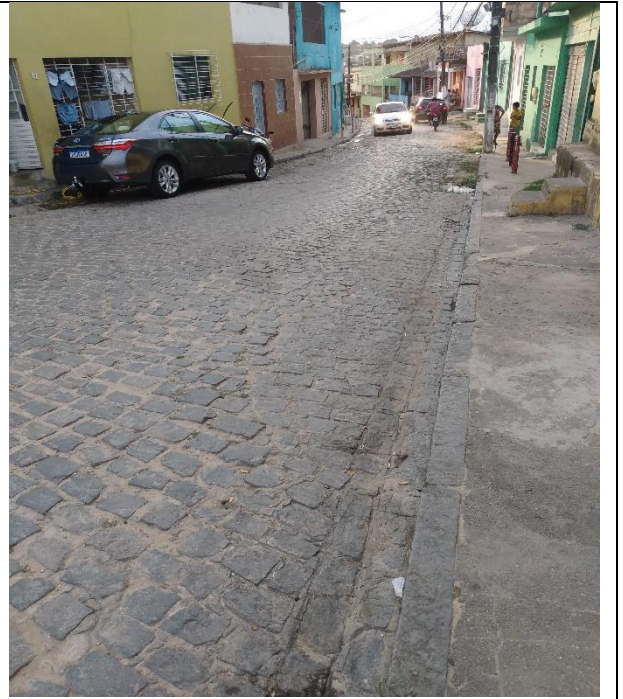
RUA SÃO JORGE - NOVA DESCOBERTA
